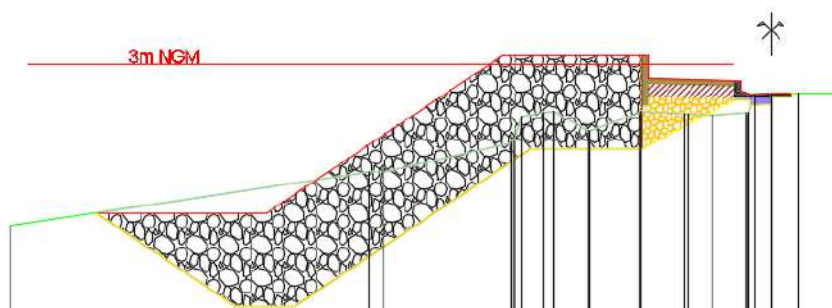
exemple de profil en travers de la solution du muret de hauteur fixe
